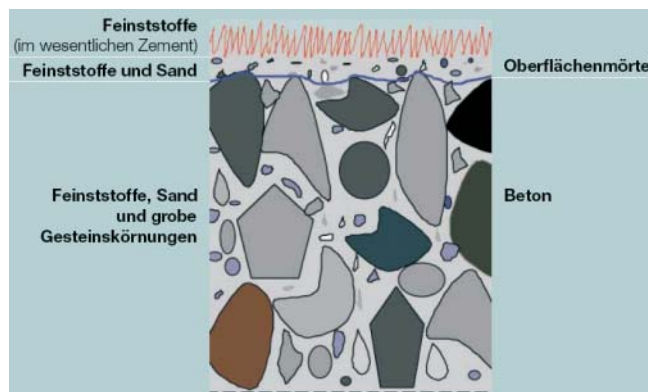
Die oberflächennahen Zonen der Betondecke nach der Herstellung (nach [8])
